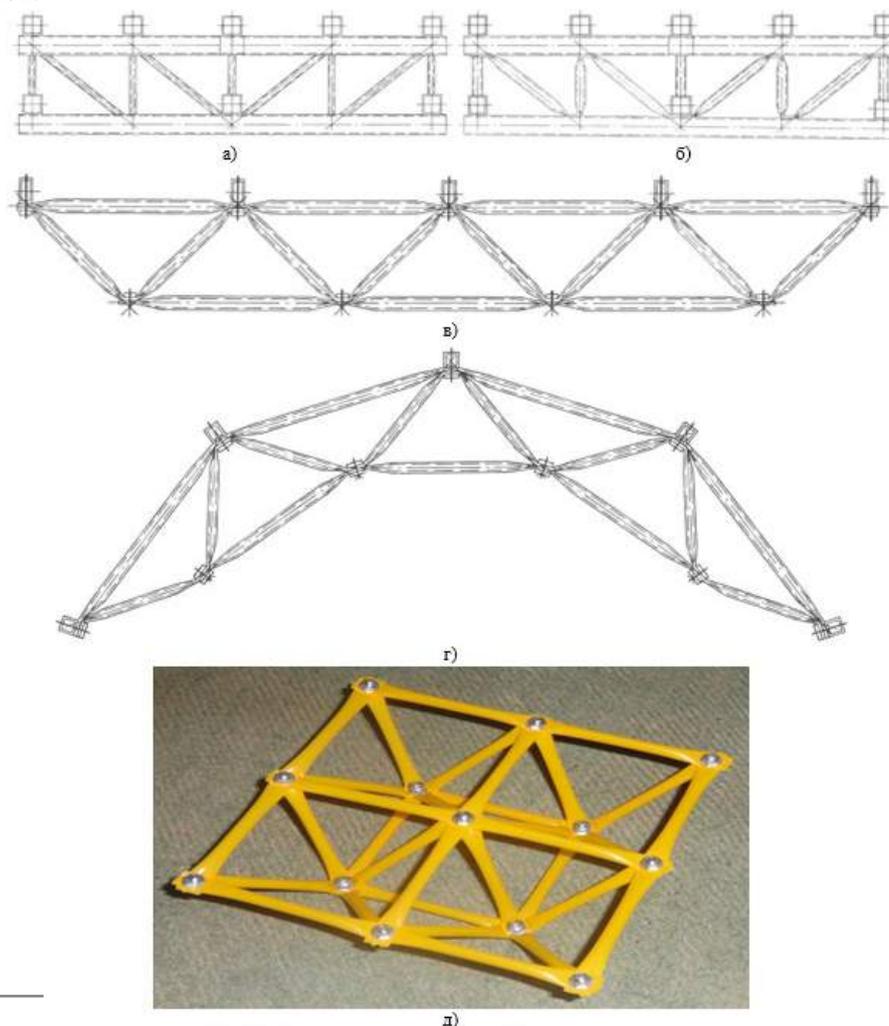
Схемы несущих конструкций из профильных труб: а – перекрестных ферм типа «Пятигорск» без сплющиваний и гибов элементов решеток; б – перекрестных ферм типа «Пятигорск» со сплющиваниями и гибом элементов решеток; в – фермы со сплюснутыми элементами поясов и решетки, а также их болтовыми соединениями; г – фермы арочного очертания со сплюснутыми элементами поясов и решетки, а также их болтовыми соединениями; д – структурной конструкции со сплюснутыми элементами поясов и решетки, а также их болтовыми соединениями
